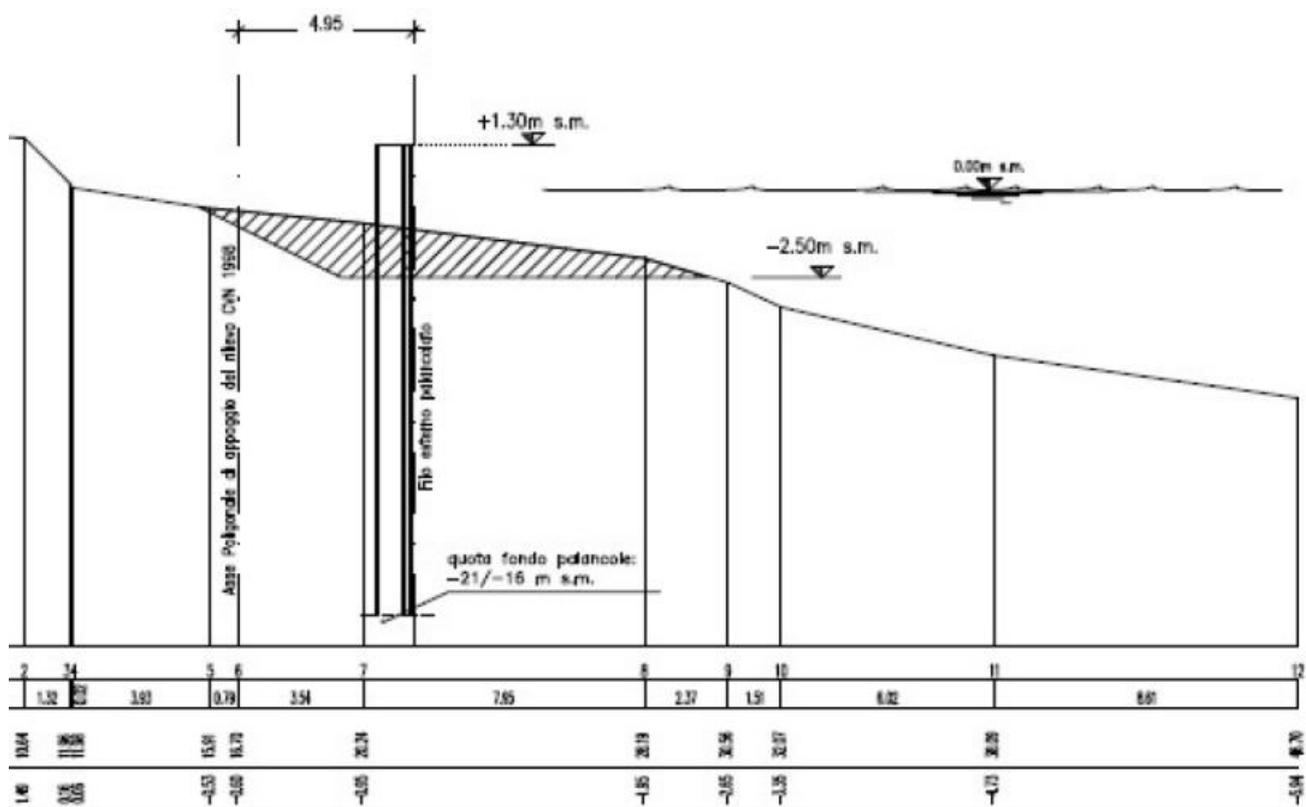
Sezione con indicazione della quota del fondale attuale e del posizionamento delle palancole – particolare
